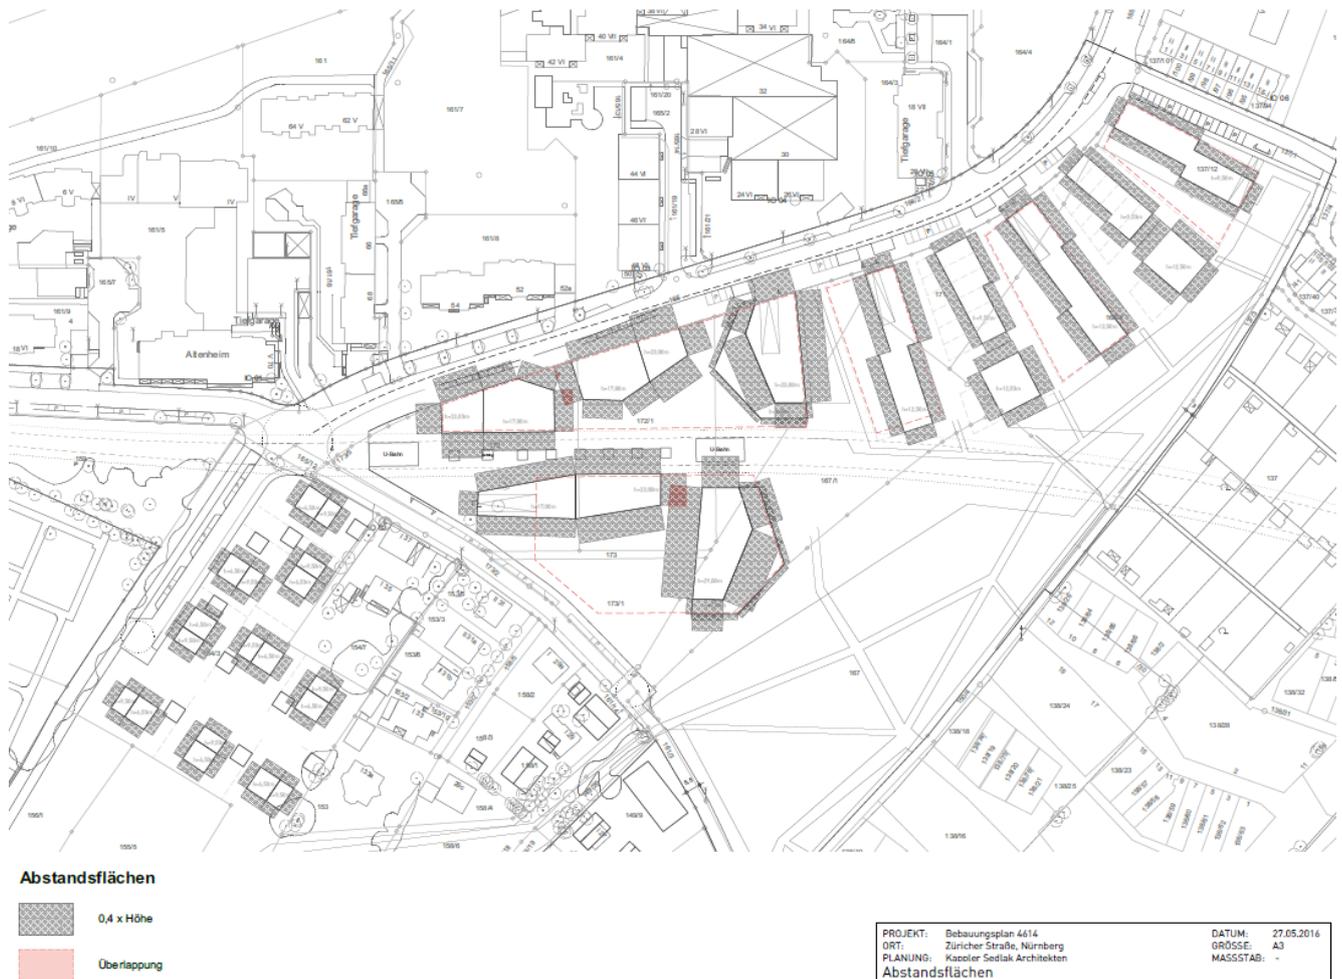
Abstandsflächenplan mit 0,4 H
